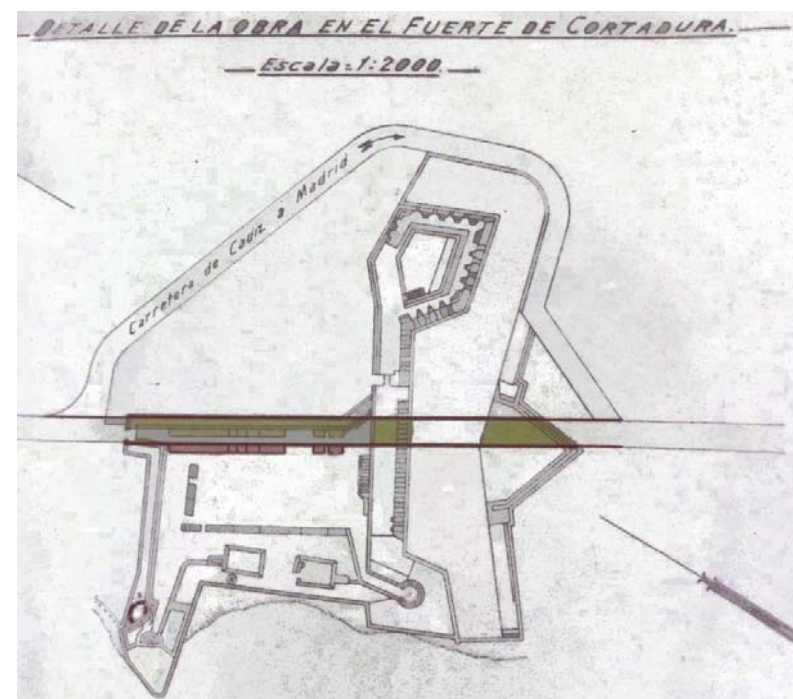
Plano de proyecto de la rectificación de la carretera Cádiz Madrid.
